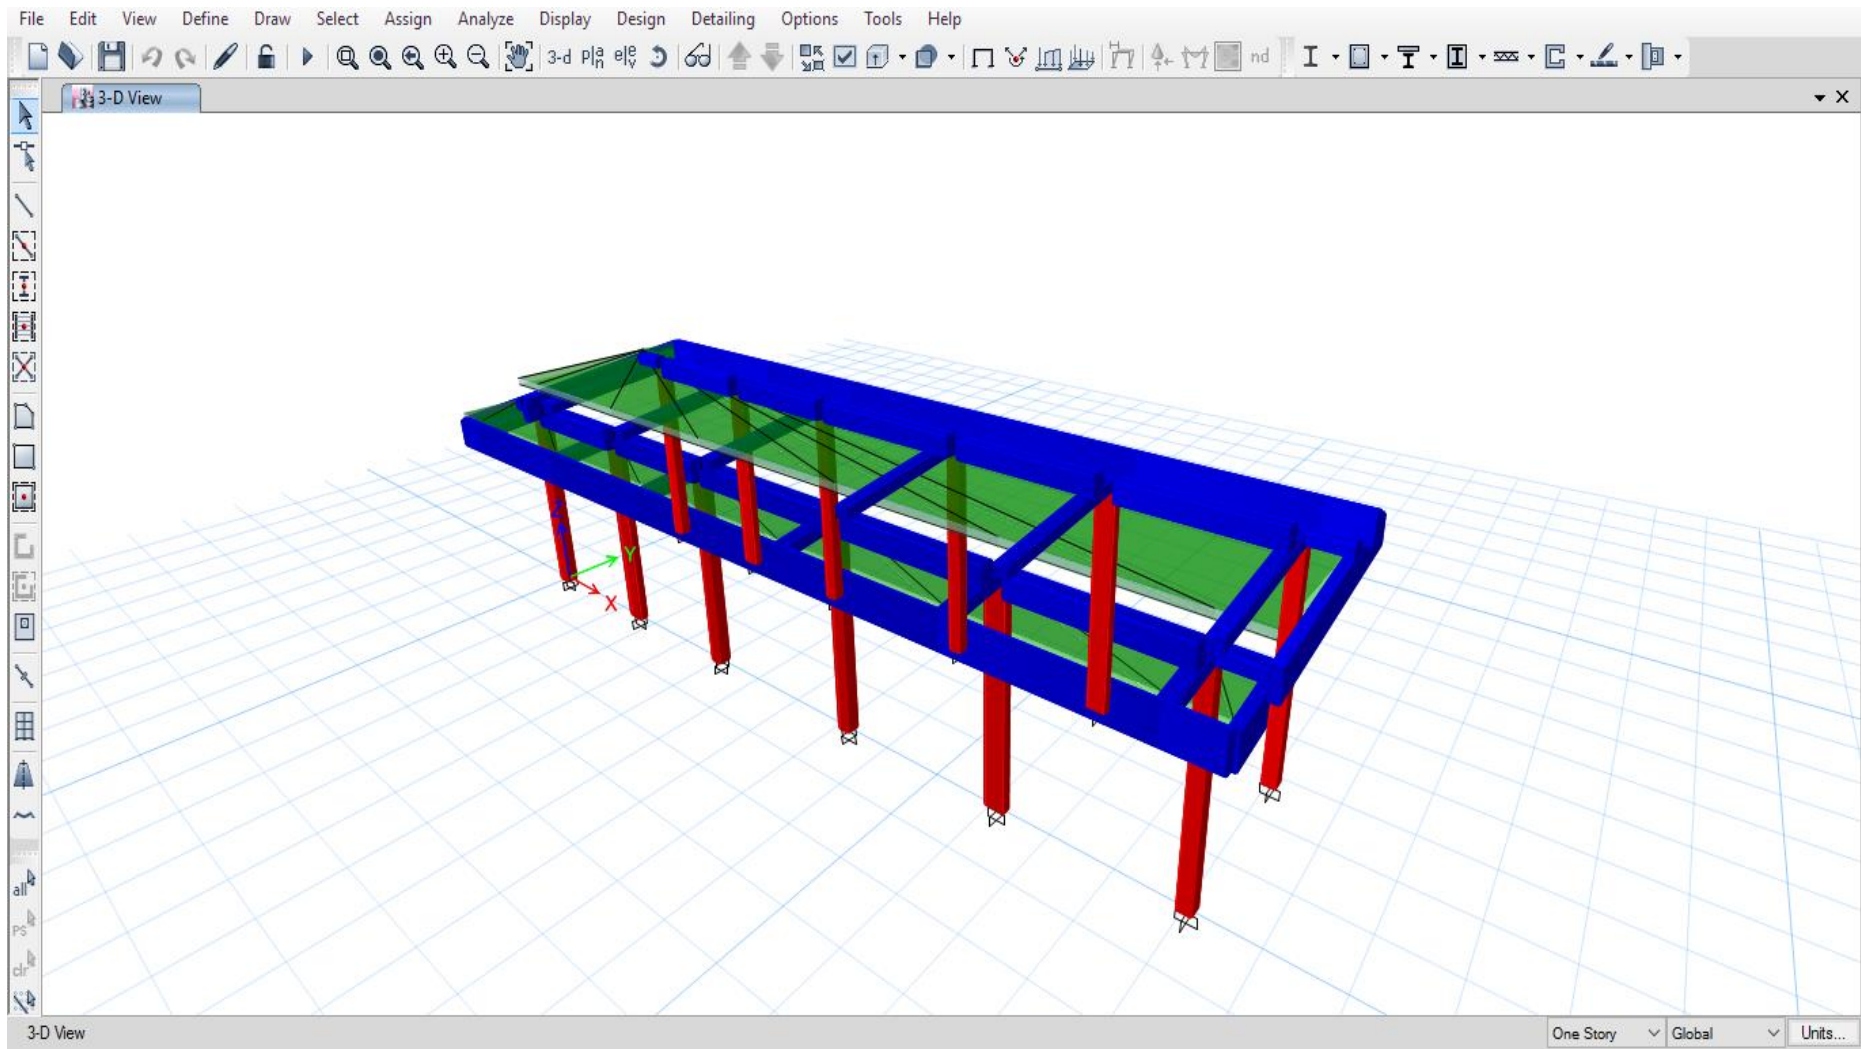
Modelamiento estructural (Edif. N° 06–SS.HH Exterior)
